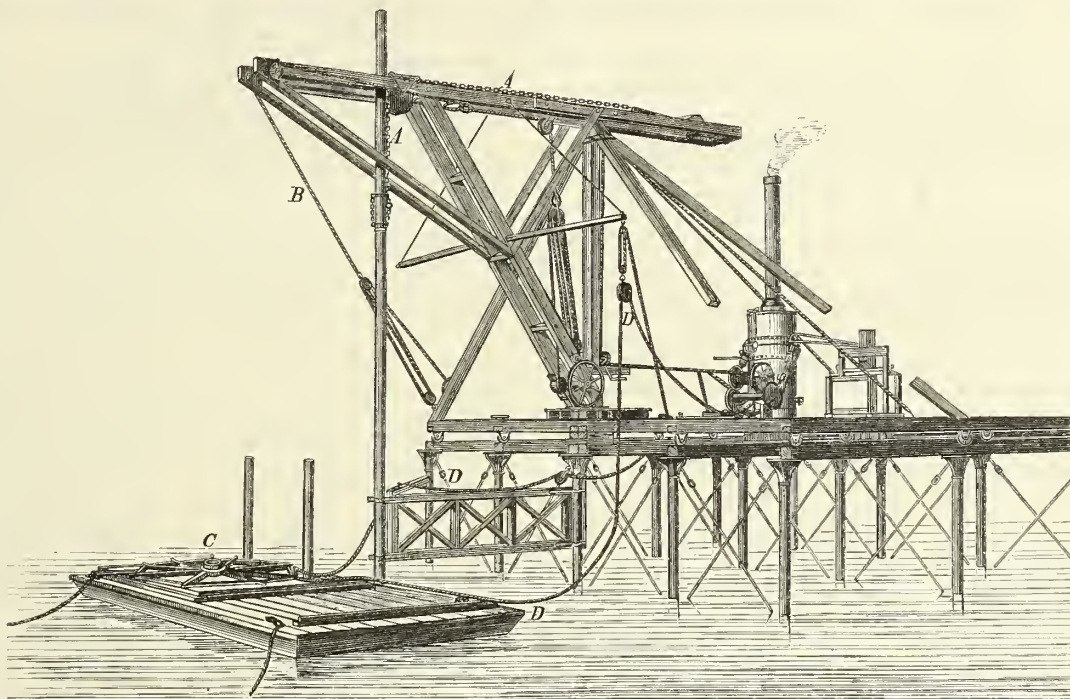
Gerüst zum Einschrauben der Pfähle beim Bau einer Landungsbrücke am Delaware.
